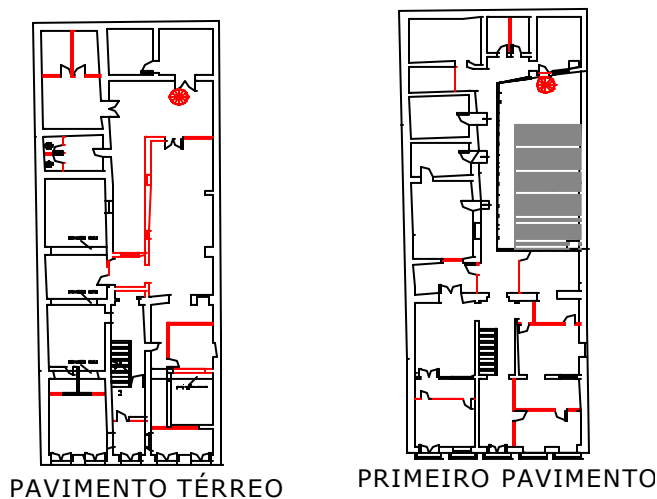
Planta Baixa Térreo e 1º Pav.
